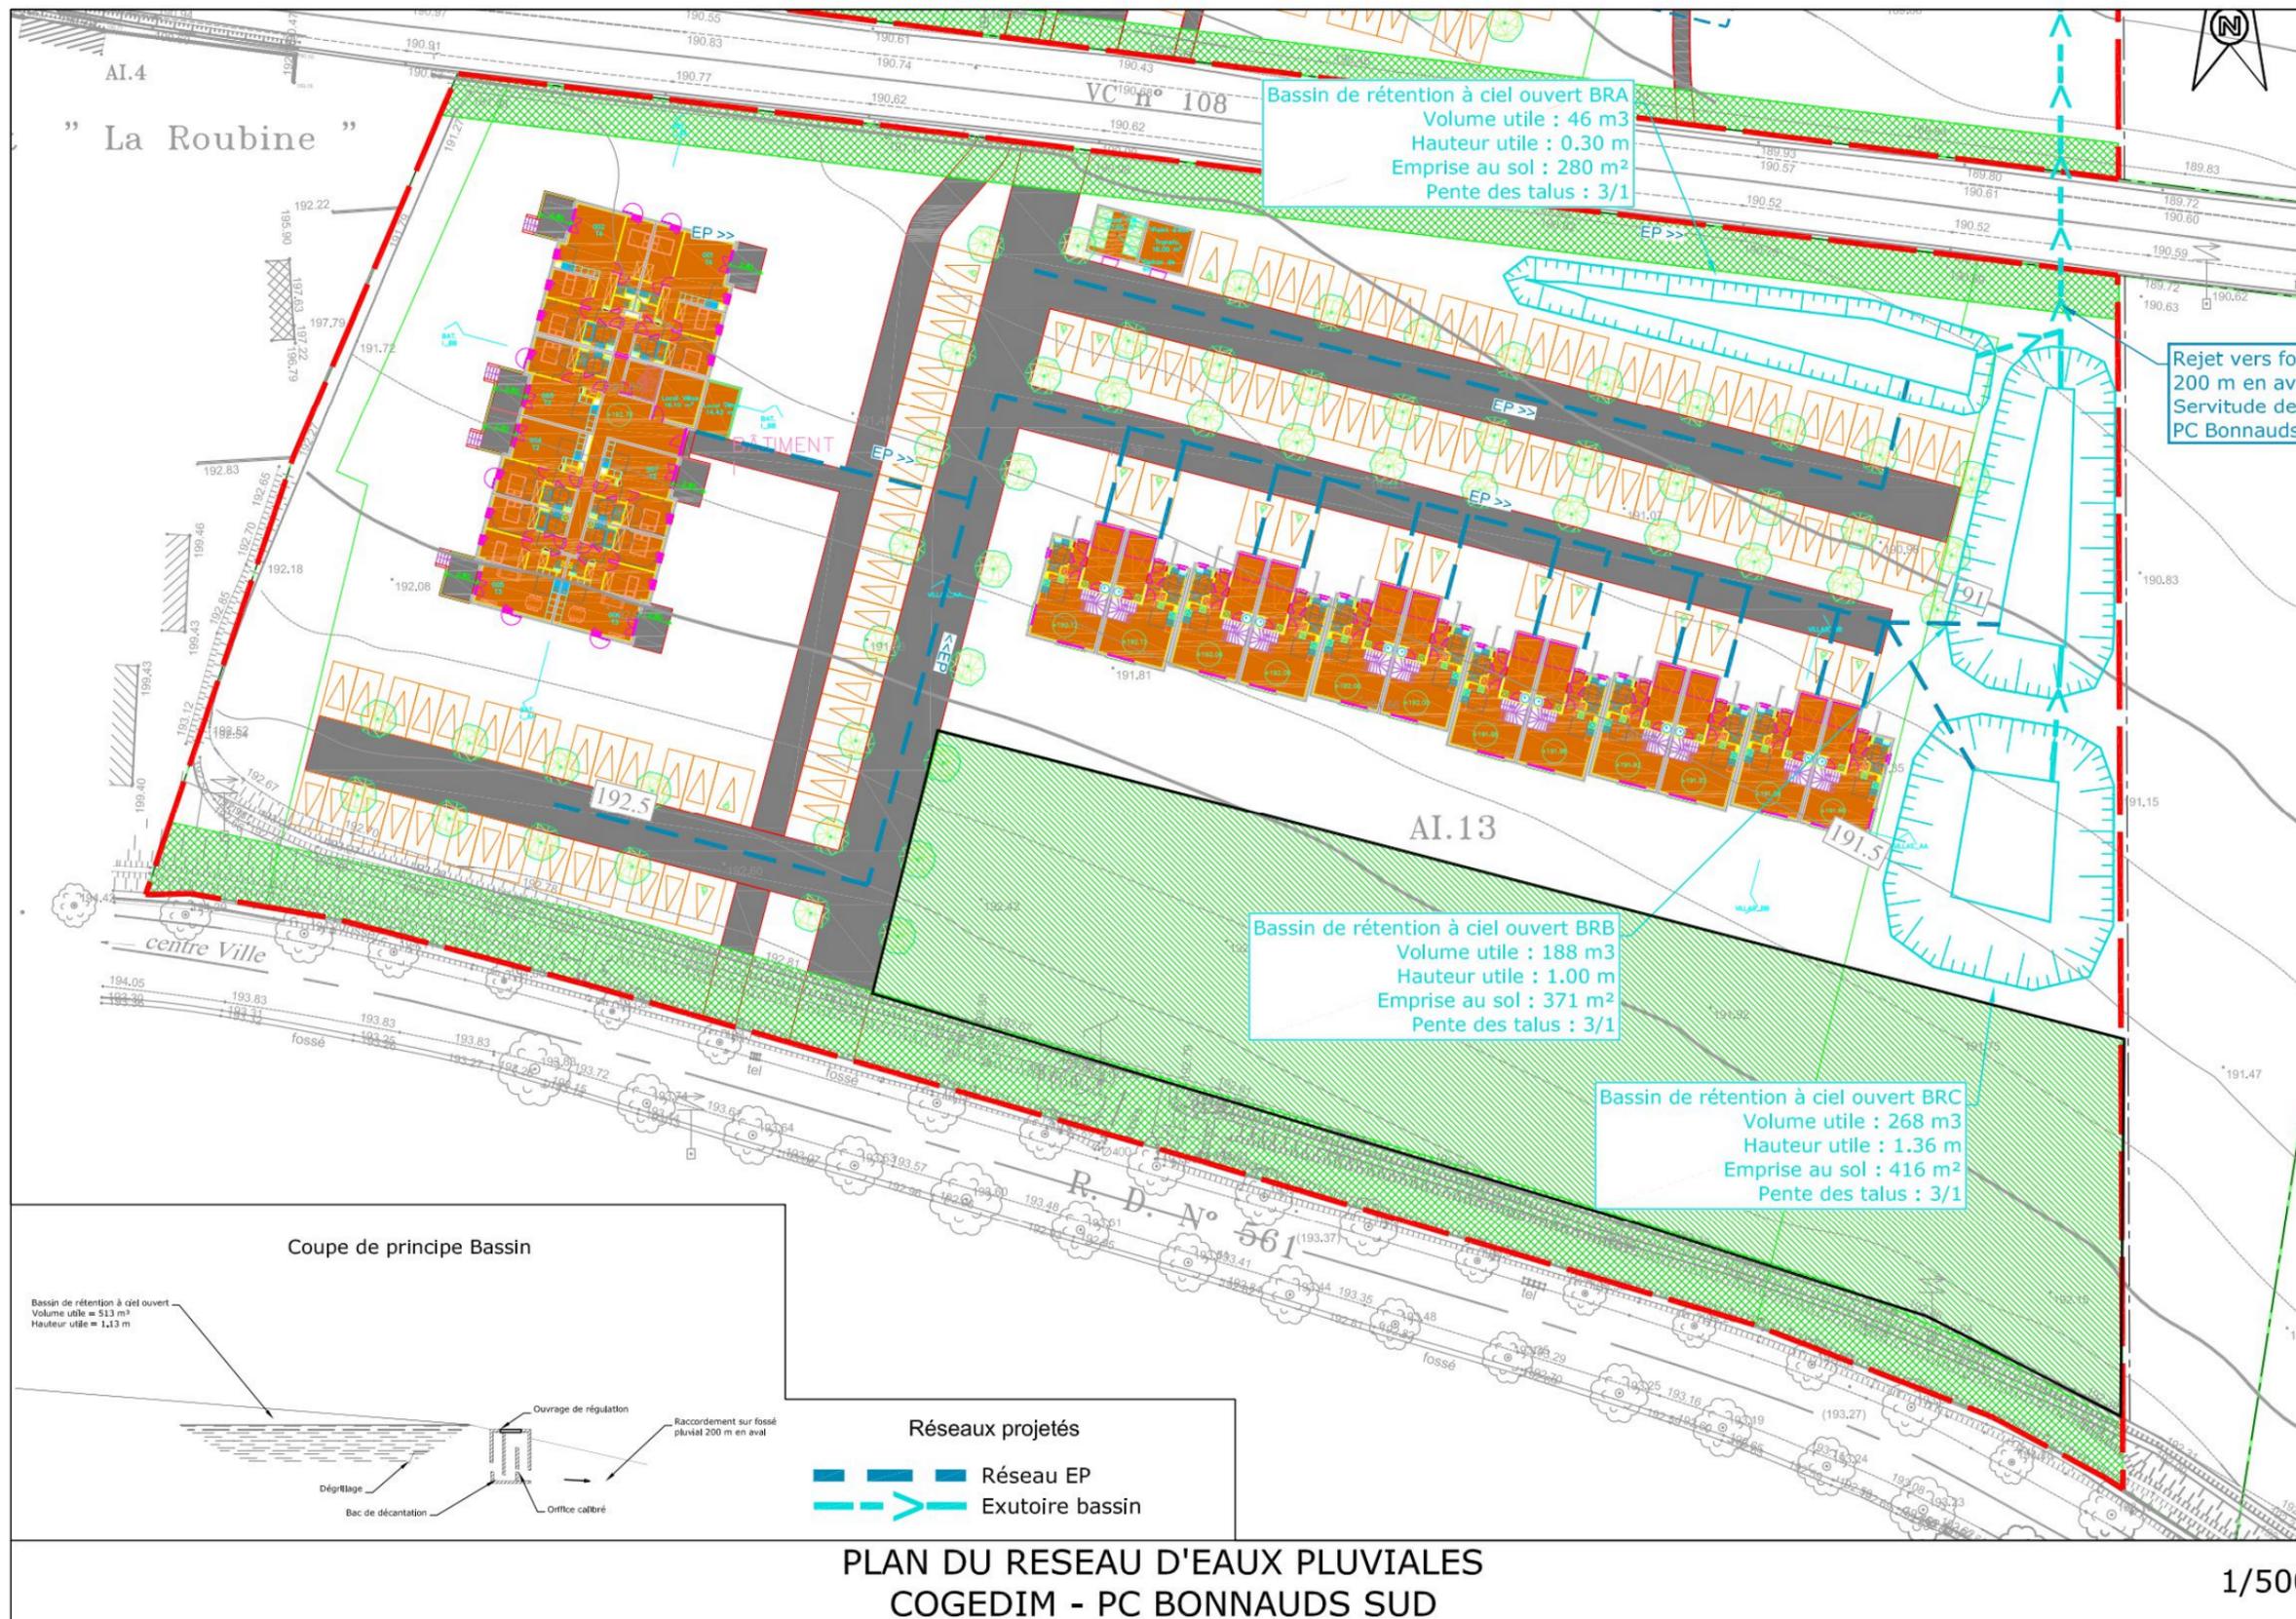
Plan des bassins de rétention des eaux pluviales au Sud du projet (source : Etude hydraulique CERRETTI)
